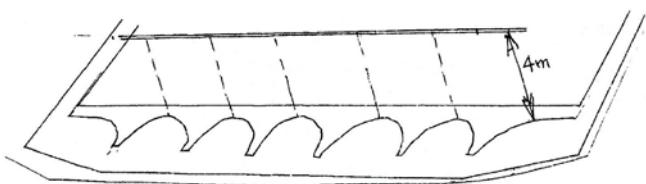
Desenho esquemático da posição das armaduras que saem da base e se amarram no sarrado a 4 m. de altura. (*-5).
